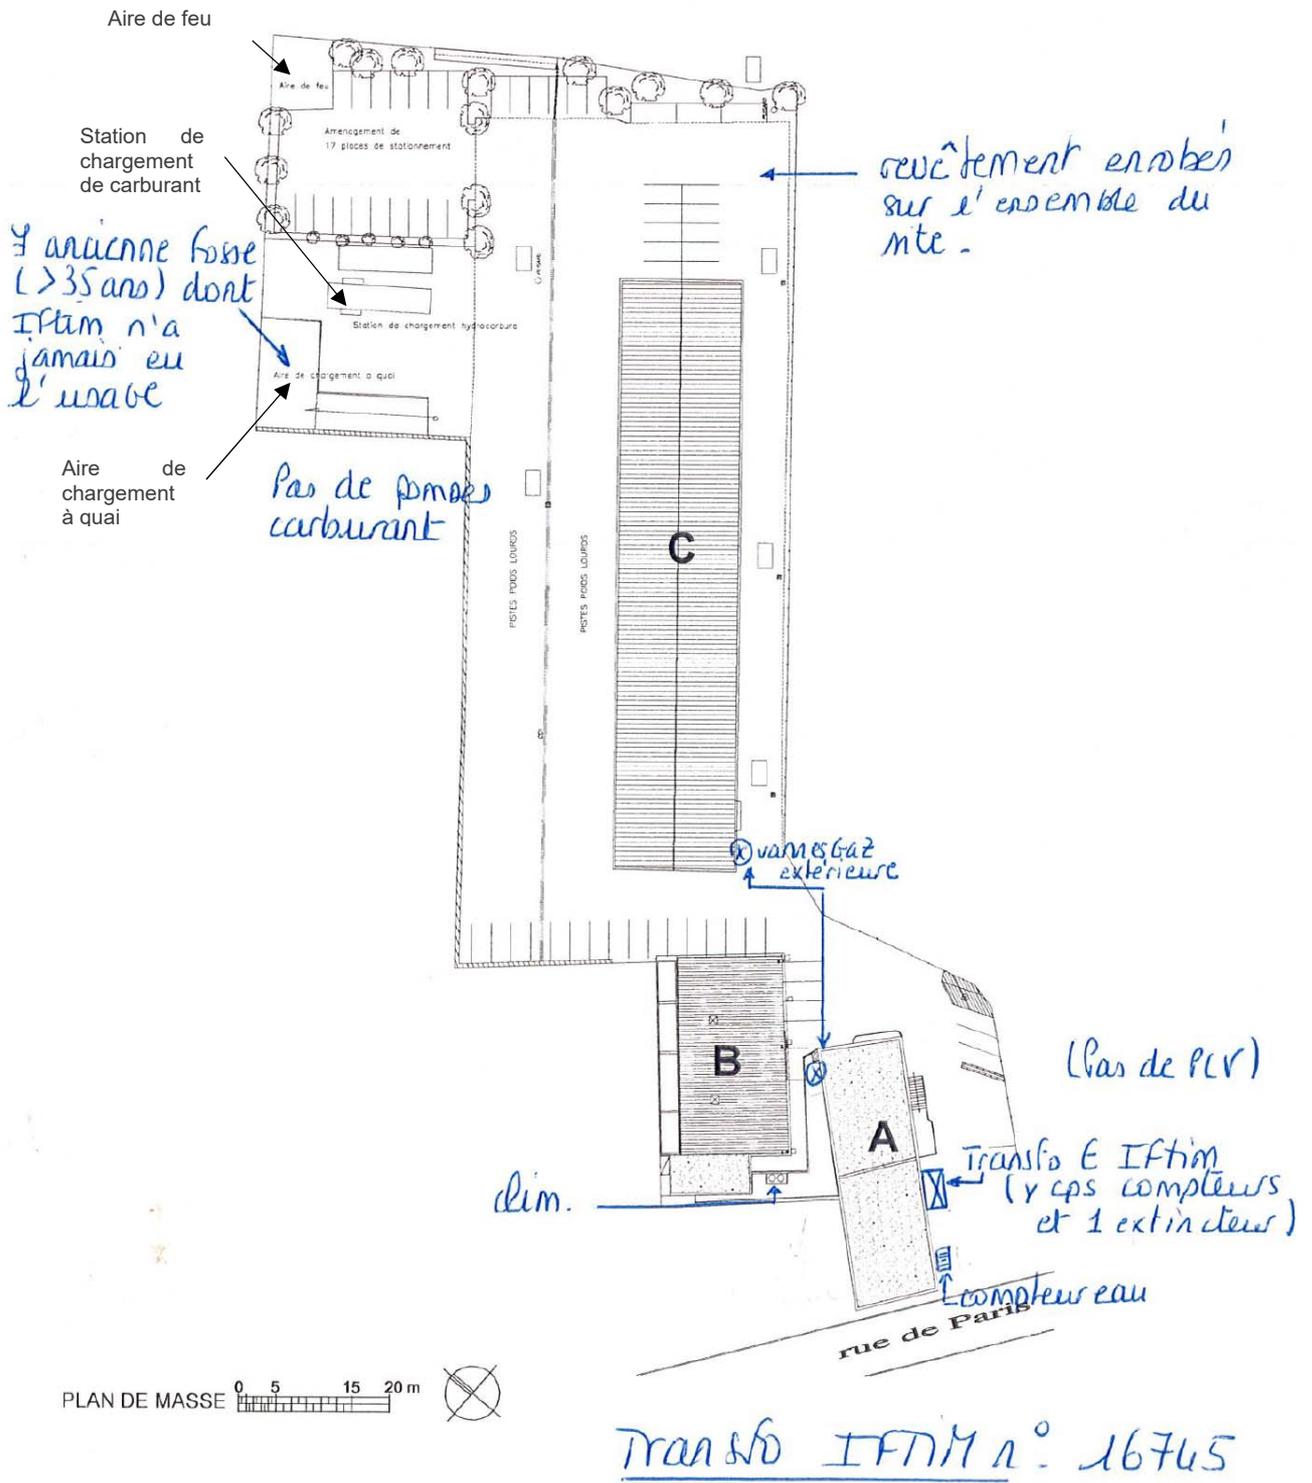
Plan masse du site (source : document d'identification AFT IFTIM)
